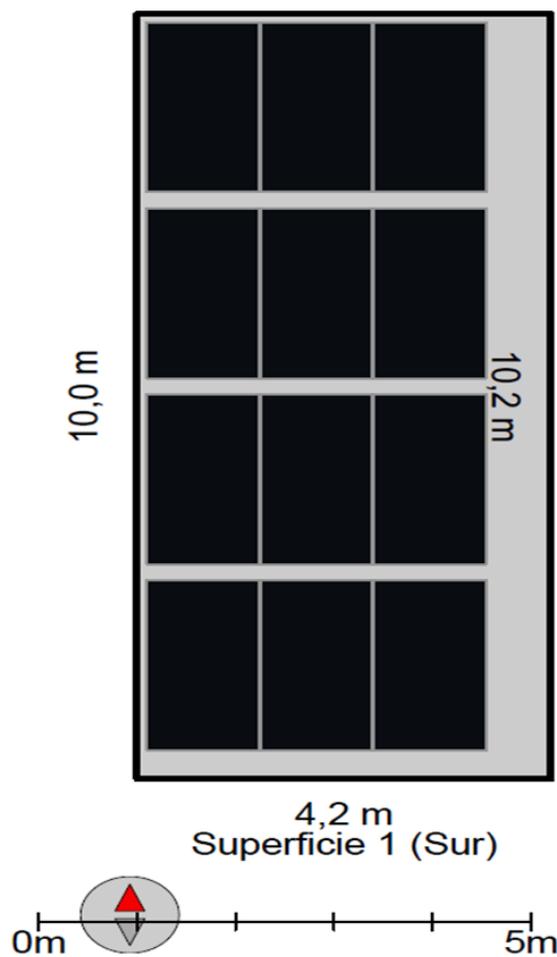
Figura D - Distribución de Paneles en el Techo Vivienda Tipo
